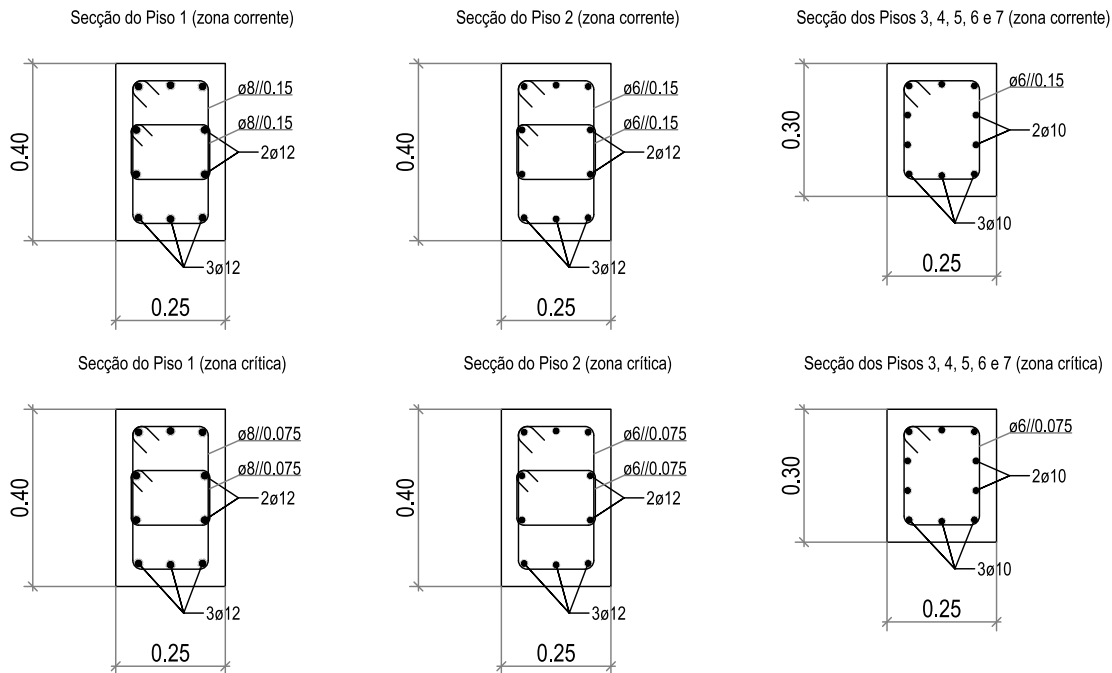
Edifício real e modificado: Secções de armadura do pilar de fachada (P2)
